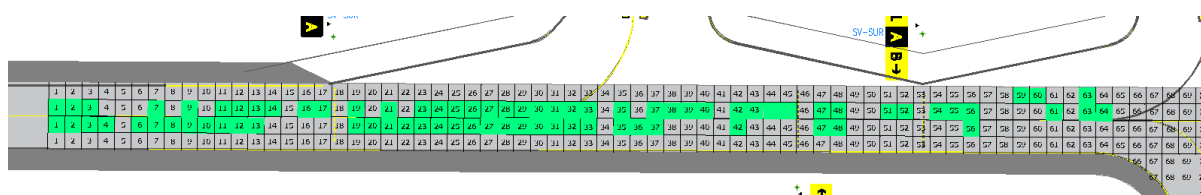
Plano de Etapa 1 – Losas desde módulo 1 al módulo 64
